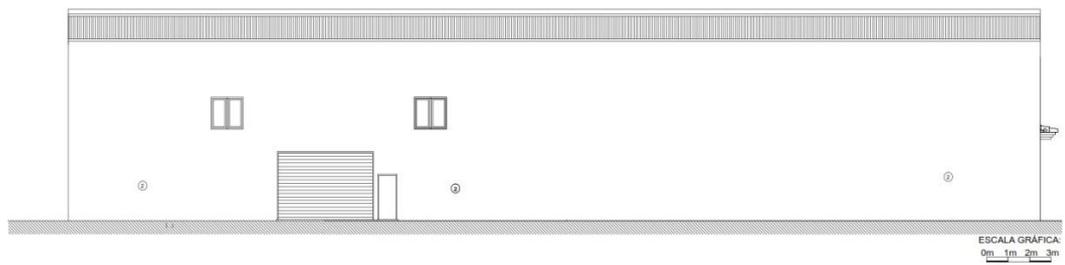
Adega Quinta da Vinha – Alçado Posterior⁶⁰
